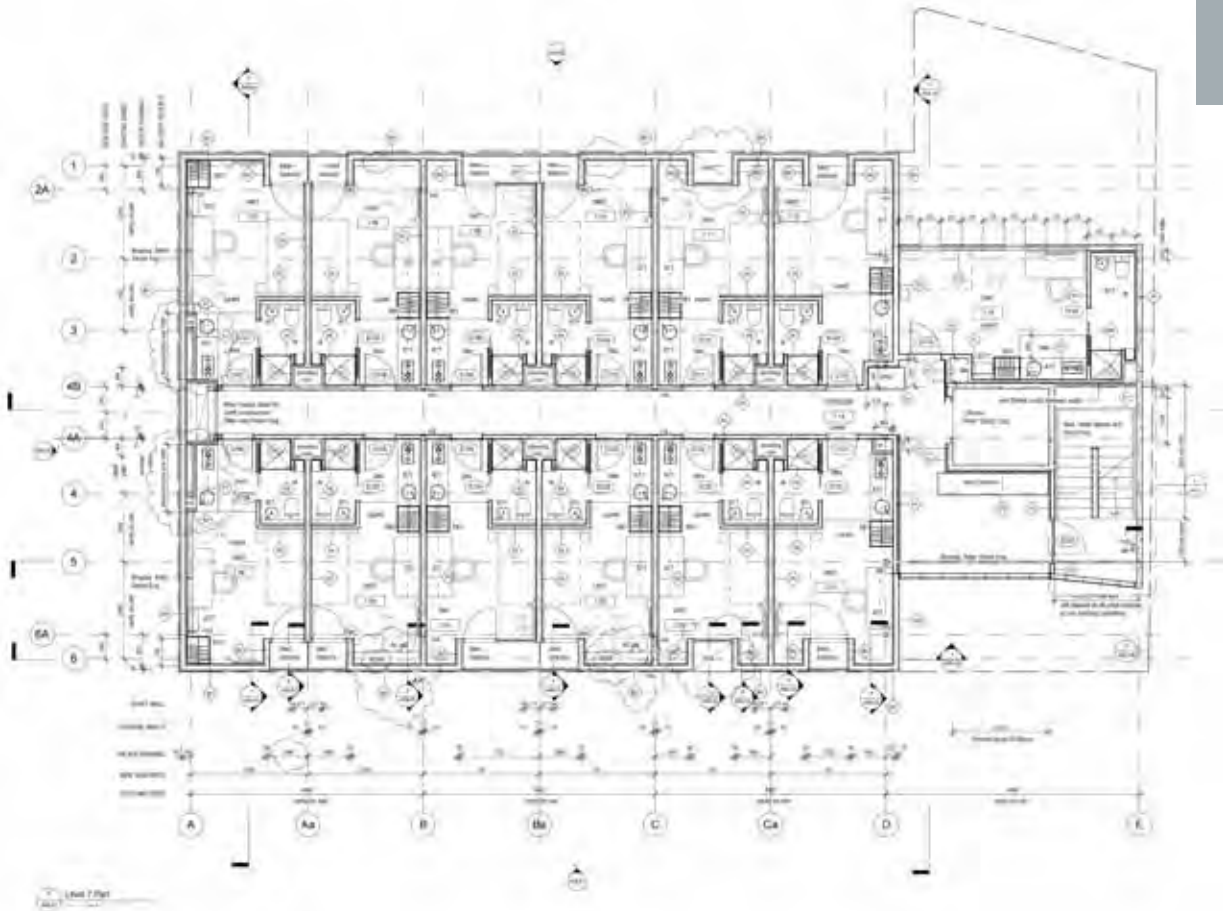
Grundriss 7.OG © Hayball Architects
